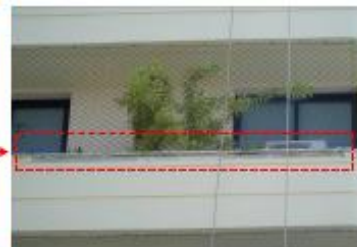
Detalhe do marmore removido no 8º pavimento da fachada sudoeste, lado direito.
